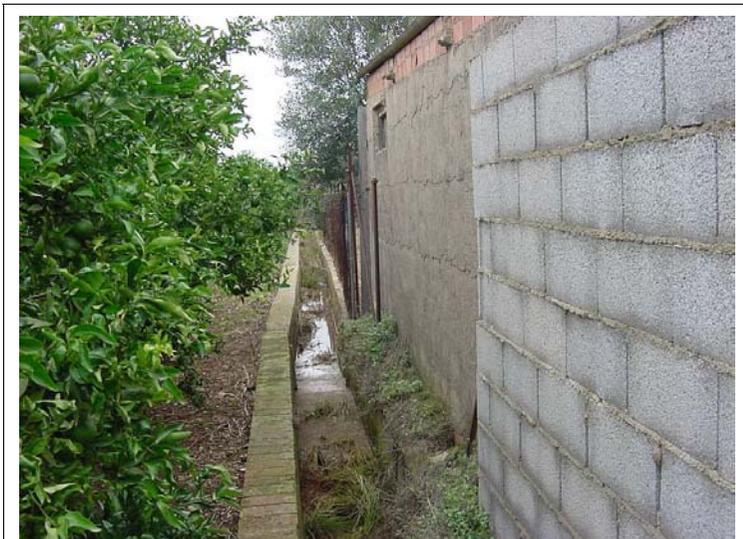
Almacenes de una altura, murete de hormigón de 60 cm de altura y valla metálica de 2 m de altura.
